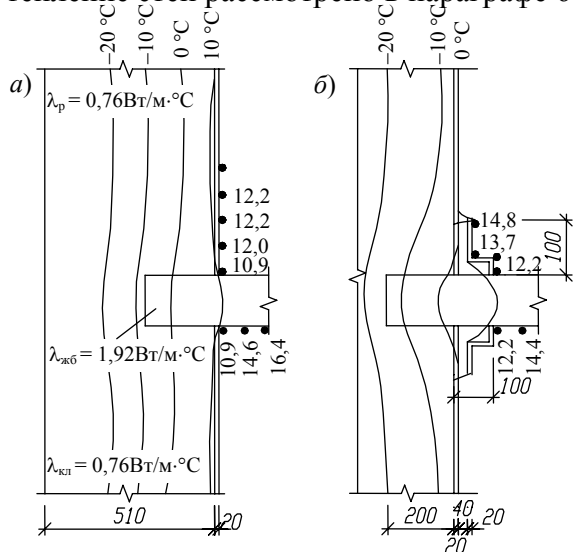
Температурные поля в месте опирания железобетонных плит на кирпичную стену:
